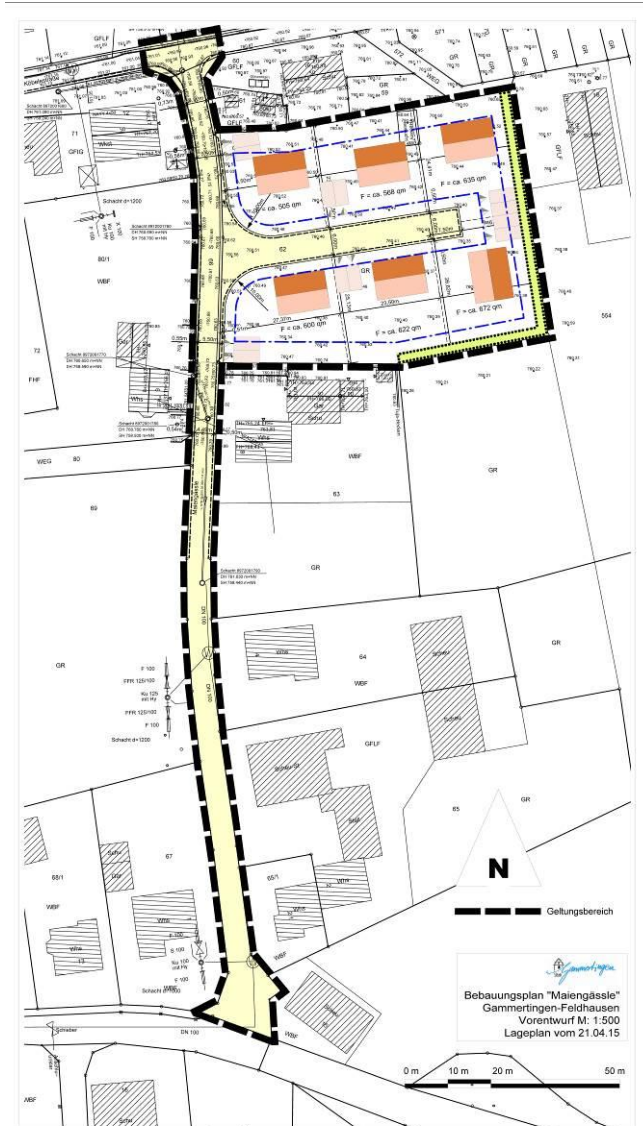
Entwurf des Bebauungsplans, Stand 21. April 2015 (unmaßstäblich)
